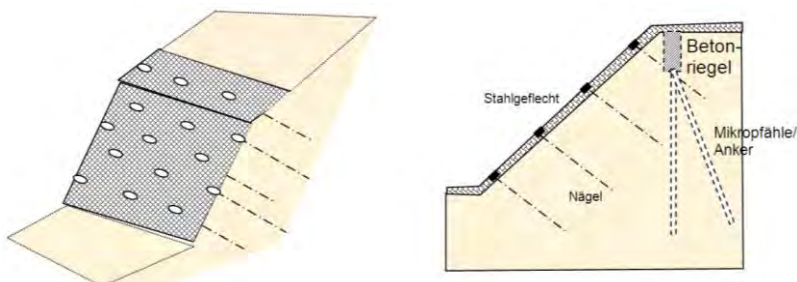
Konstruktionsschema Erdbetonstützscheiben
